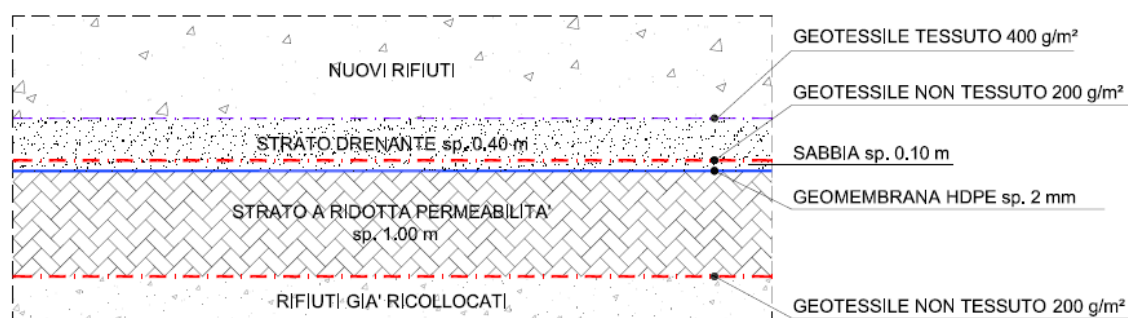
Schema di impermeabilizzazione del fondo della discarica.
